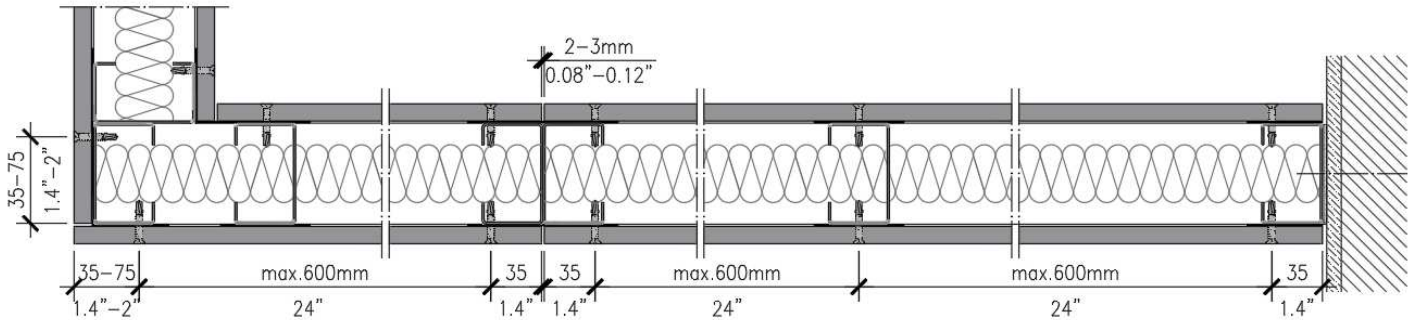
Section horizontale de la paroi, ossature acier galvanisé
